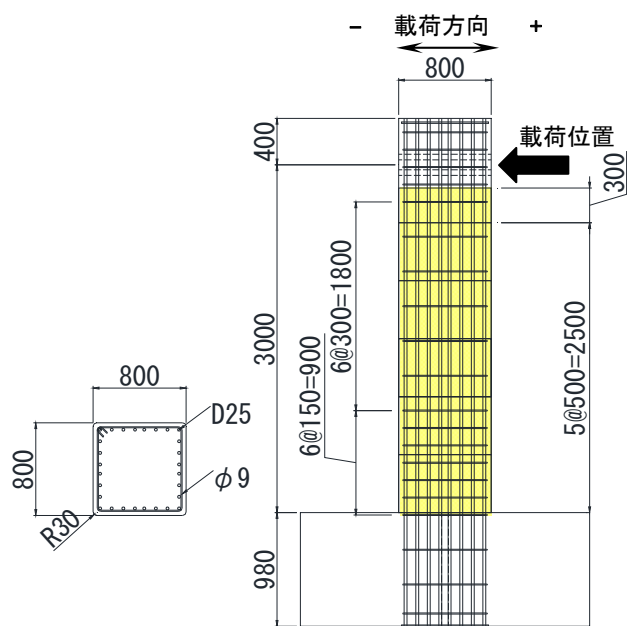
試験体寸法, 配筋 (試験体 No. 1)
